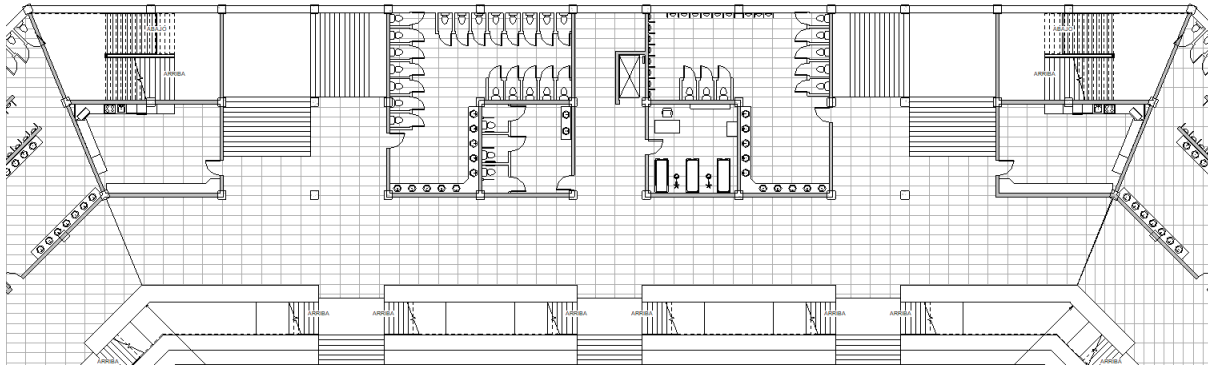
Vista en planta del sector sur del primer piso. Fuente: elaboración propia.
